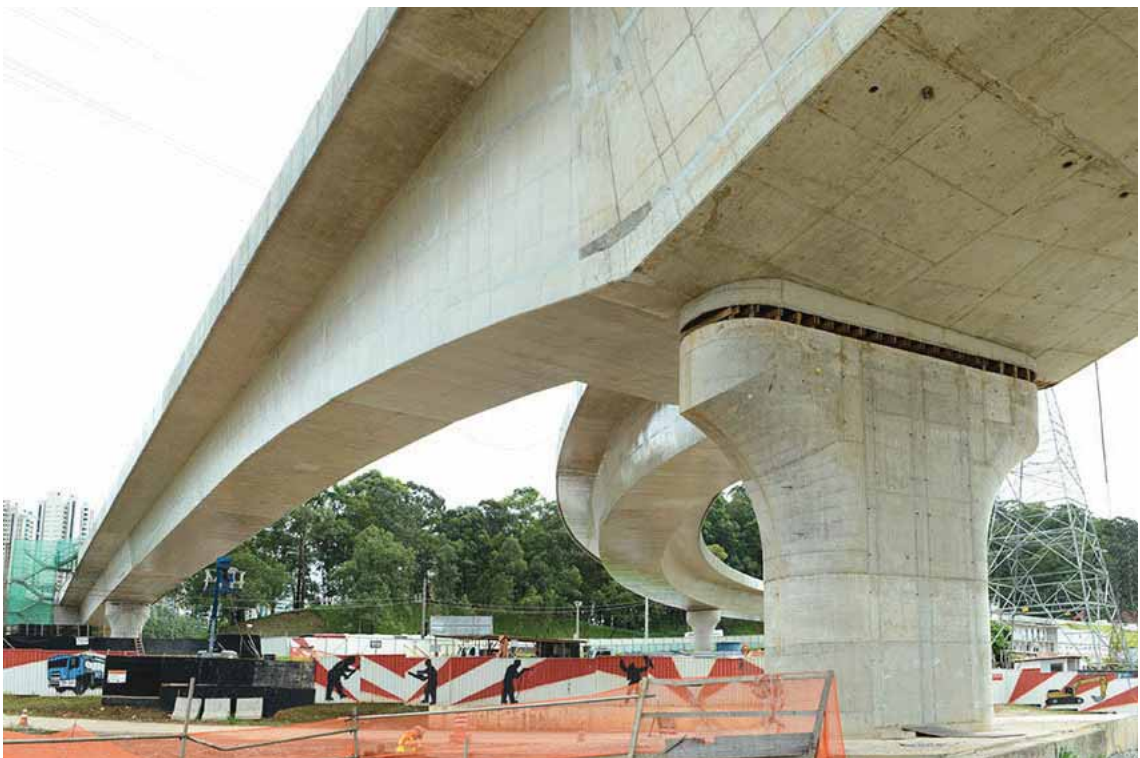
Vista inferior dos vãos entre AP2 Ramo 100/AP3 e AP4 [03/2016]
